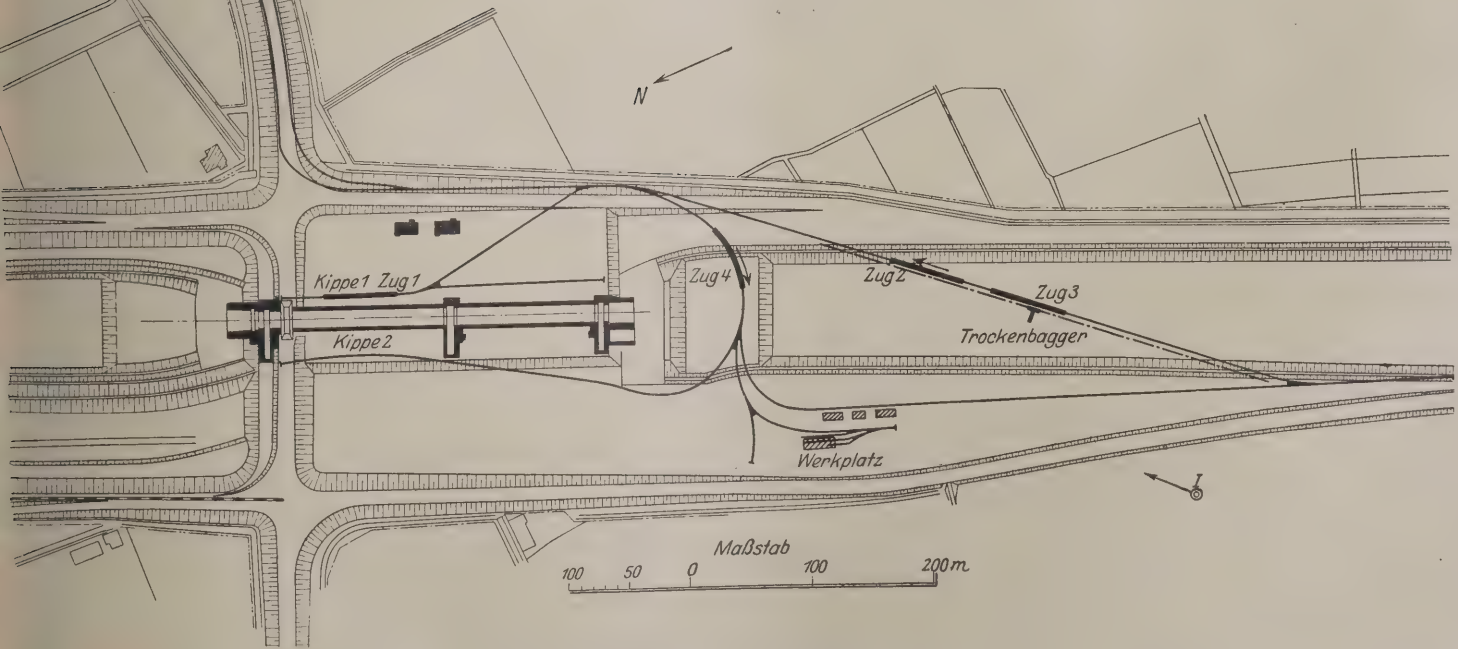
Lageplan zu den Abbildungen 4 u. 5.
